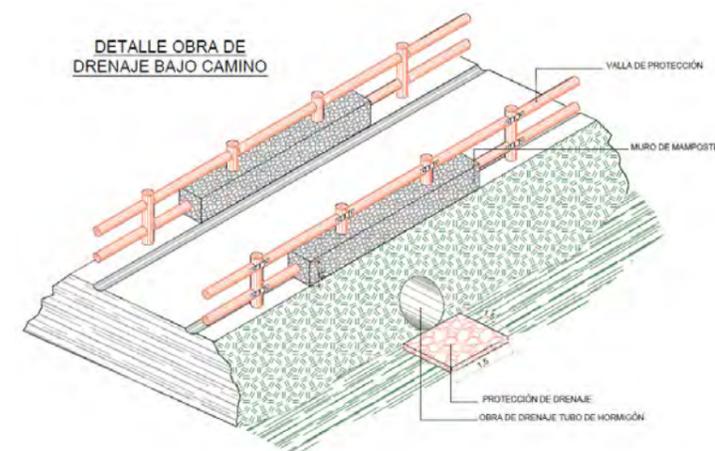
Detalle de la obra de drenaje bajo camino. Fuente: Proyecto constructivo.
